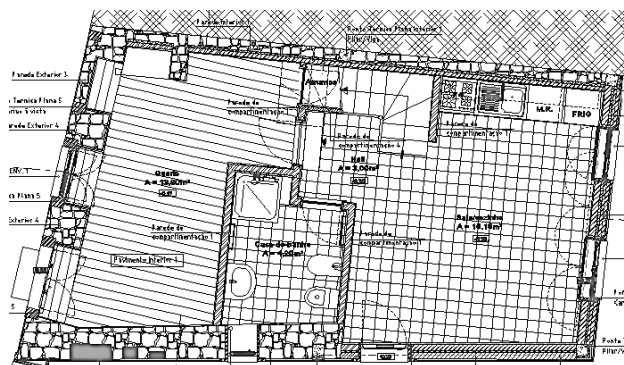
Planta do piso 0 do edifício I [arquivo de obra]
